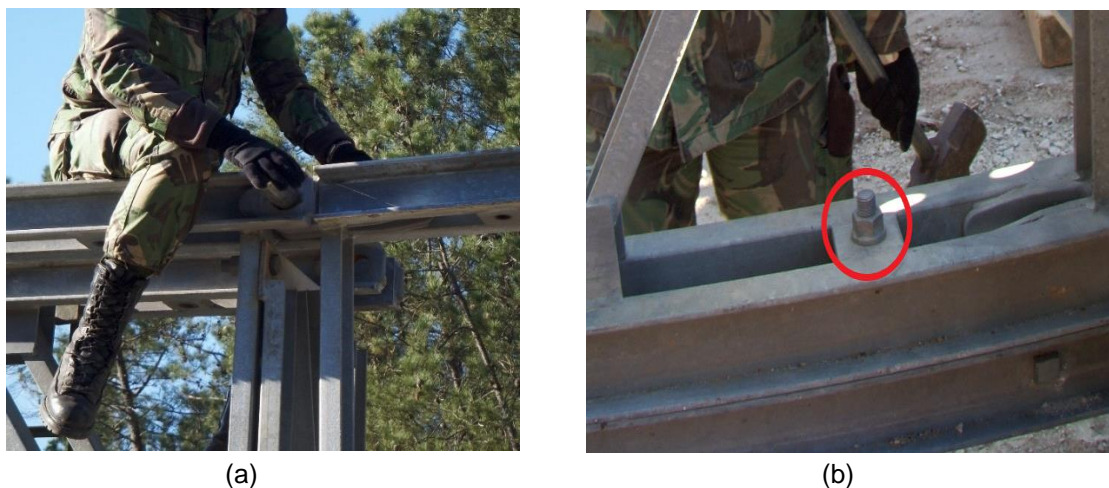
a) Colocação de uma cavilha; b) Ligação aparafusada corda/reforço-corda. Adaptado de Companhia de Pontes (2011)
